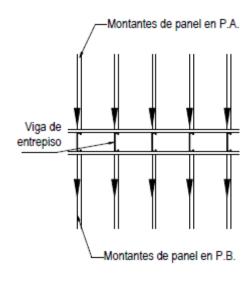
Estructura alineada de entrepiso. Fuente: (ConsulSteel, 2014).
